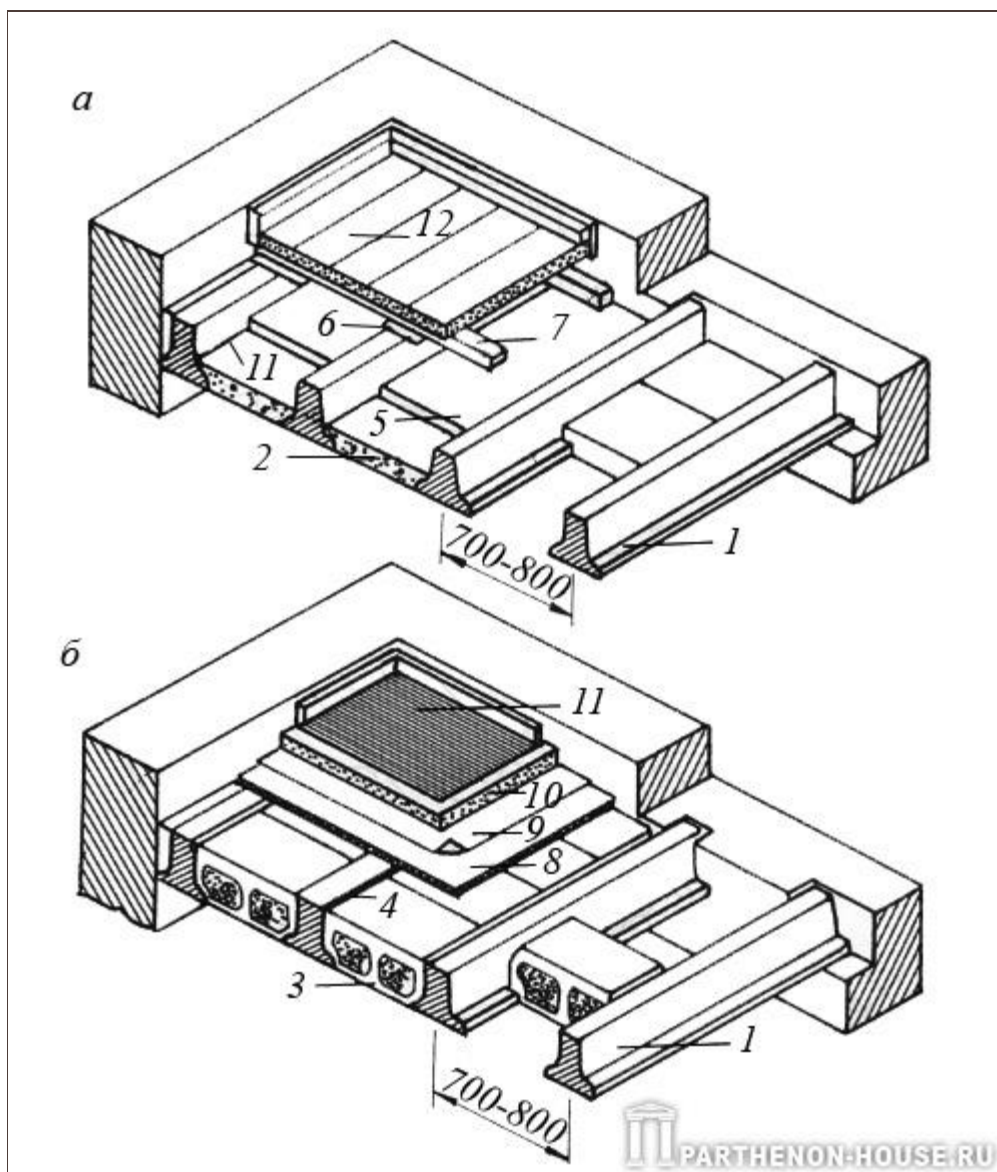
Перекрытия по железобетонным балкам (размеры в мм): А - с межбалочным заполнением в виде легкобетонных плит; Б - с заполнением межбалочных пустот пустотелыми легкобетонными блоками; 1 - балки железобетонные; 2 - легкобетонные плиты; 3 - пустотелые блоки; 4 - цементный раствор; 5 - засыпка шлаком (песком); 6 - звукоизоляционная прокладка (оргалит); 7 - лага; 9 - толь; 10 - шлакобетон; 11 - пол из линолеума на мастике; 12 - дощатый пол
